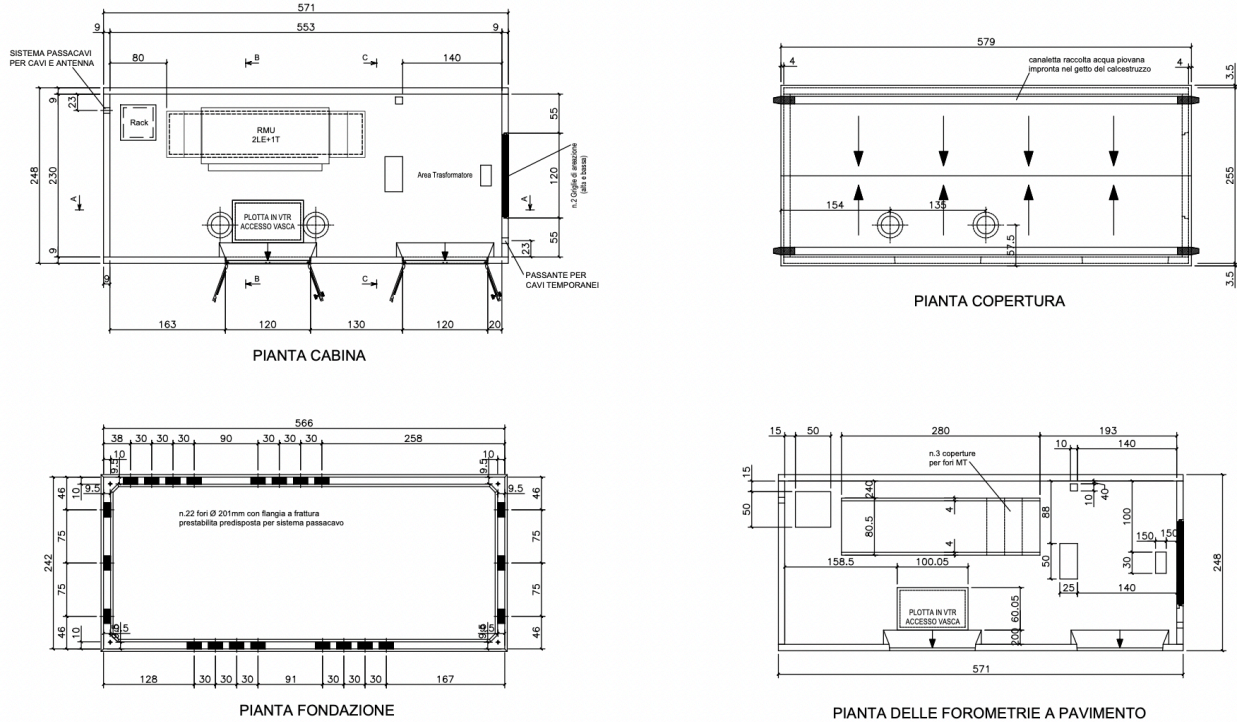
Pianta e prospetto del manufatto cabina di consegna MT (locale Utente)
